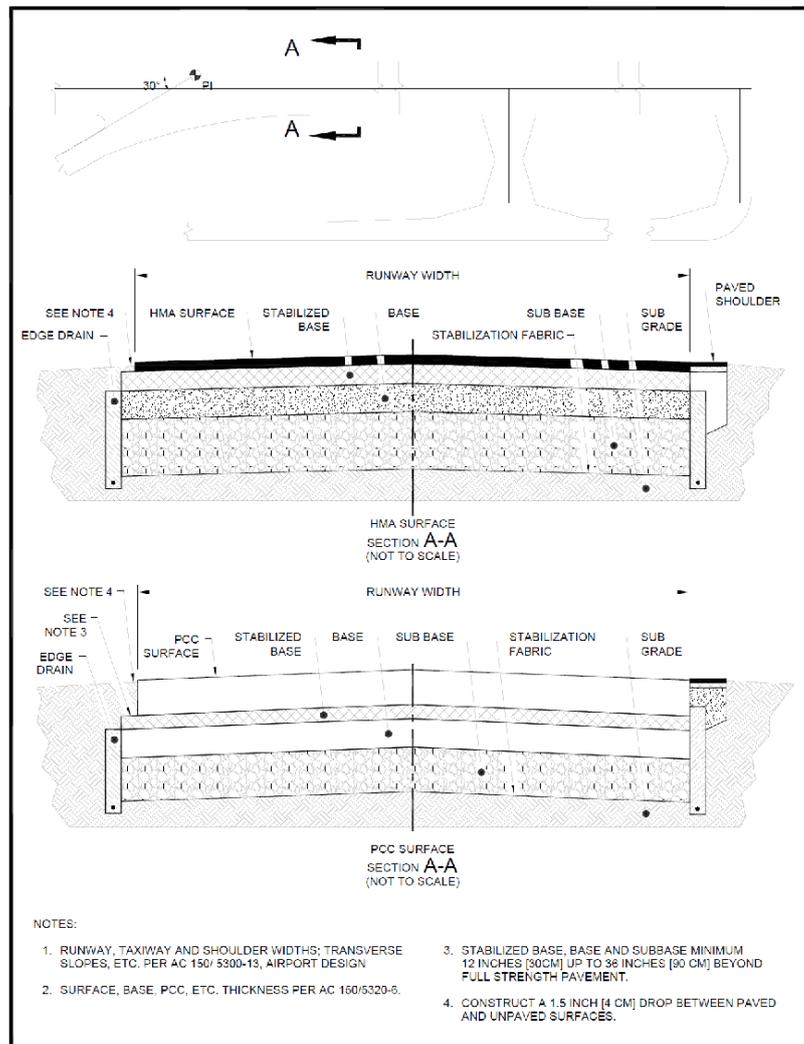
Vista en planta y elevación de la sección del pavimento.
